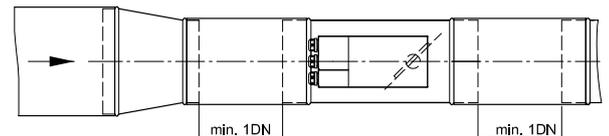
Einbau nach Störstelle, z.B. Reduzierung
